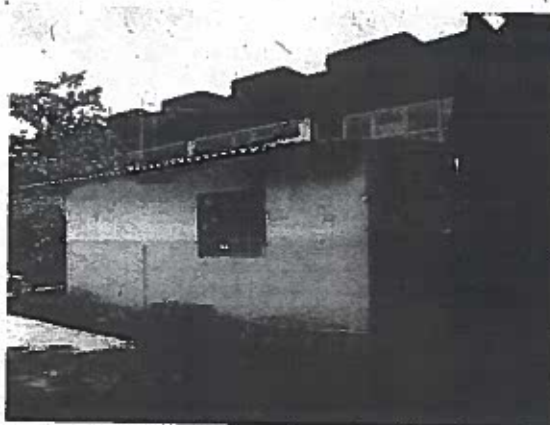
Vista Frontal/Lat. Dir. da seg. edificação
